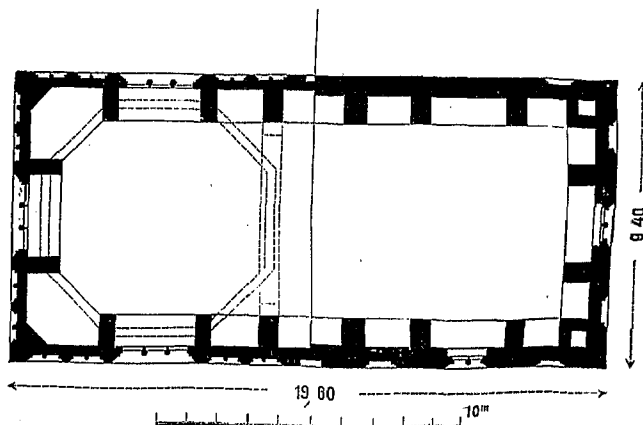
Detail-Grundriss des Thurm-Aufbaues.
